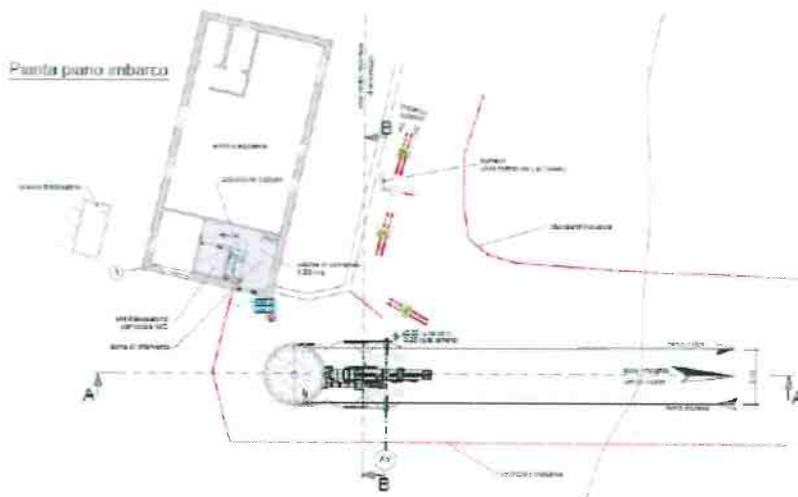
Pianta della stazione di valle in progetto e della zona d'imbarco
